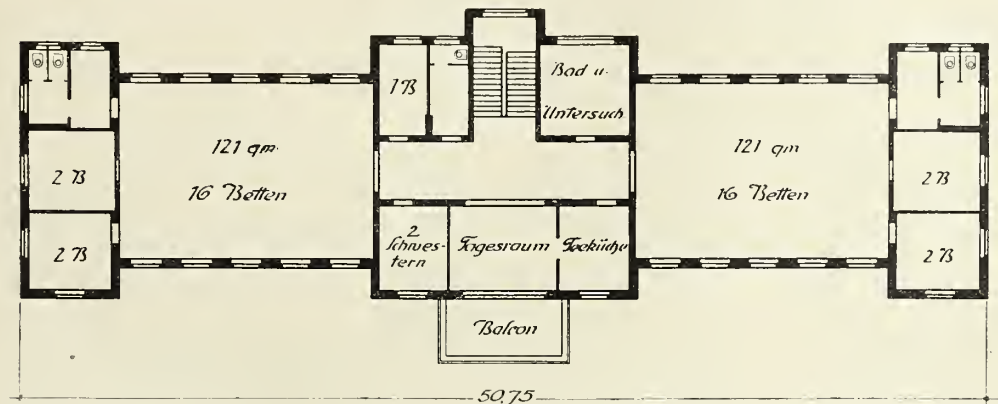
Krankenhaus St. Georg in Hamburg. Zweigeschossiger Pavillon. Obergeschoß. 41 Betten.
